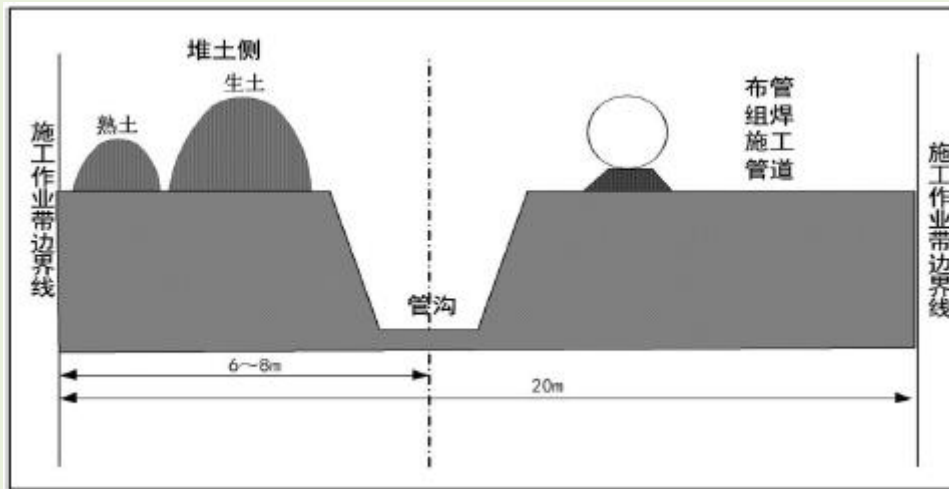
一般地段管线施工方式断面示意图（大开挖）
